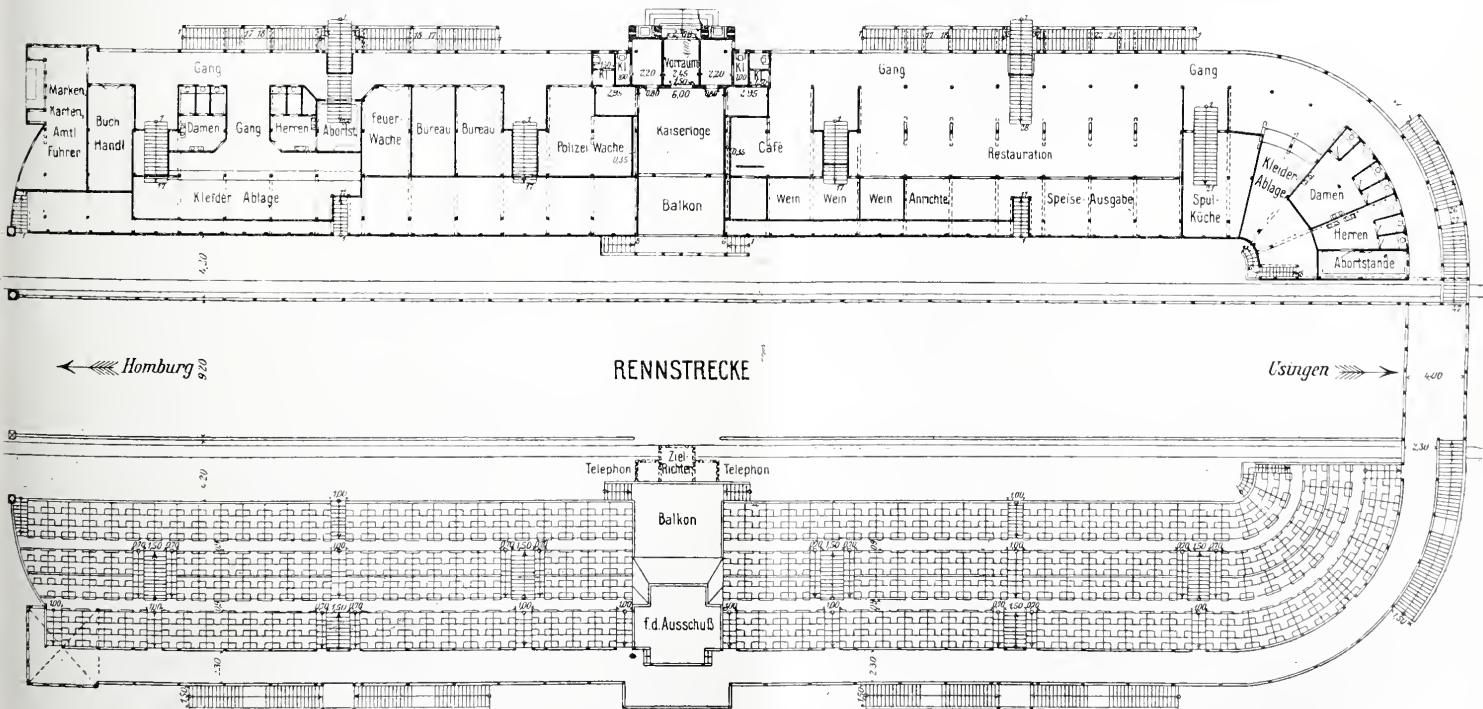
Grundrisse. Obere Hälfte: Einteilung der Räume unter der Tribüne; — untere Hälfte: Grundriß der Logen.
